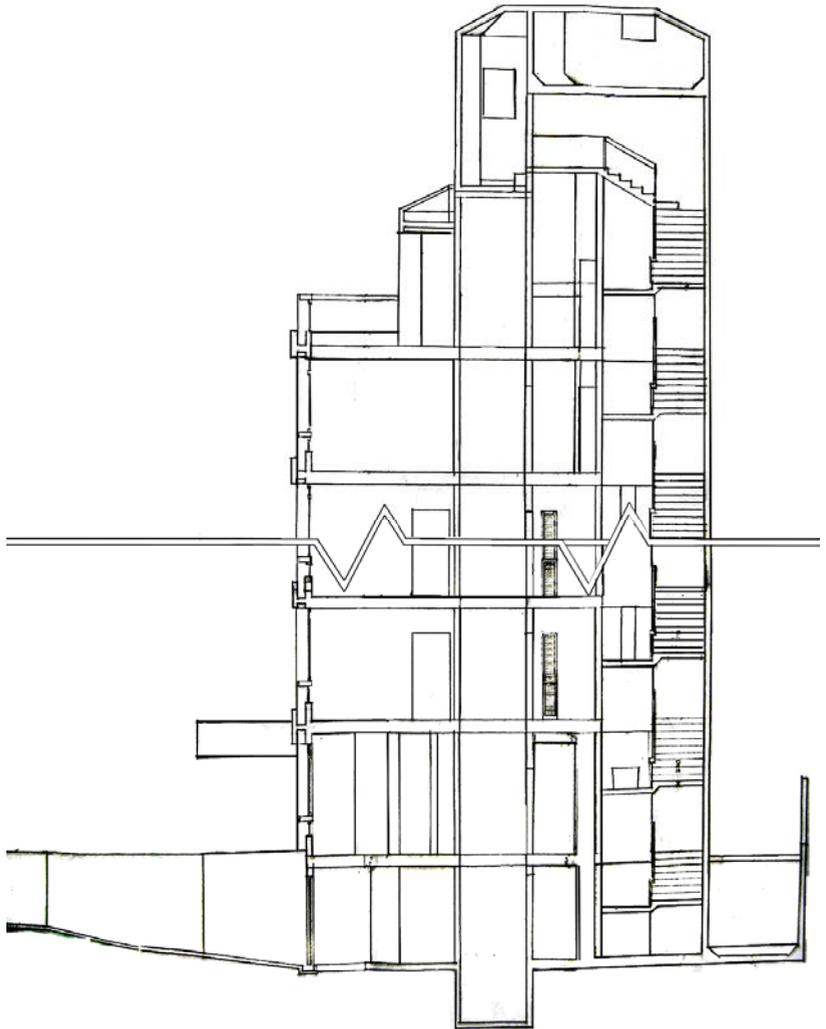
Corte transversal do edifício Guarazes com dez pavimentos.
